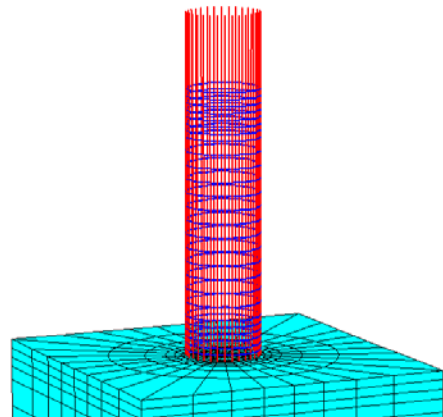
鉄筋のモデル化 (外側鉄筋のみ表示) Model of Reinforcing Bar (Only Circumference Rebars)
